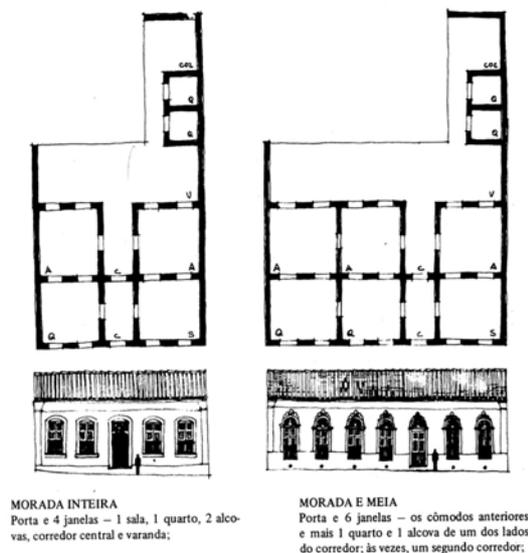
Esquema de planta baixa e fachada da morada-inteira e da morada-e-meia.
